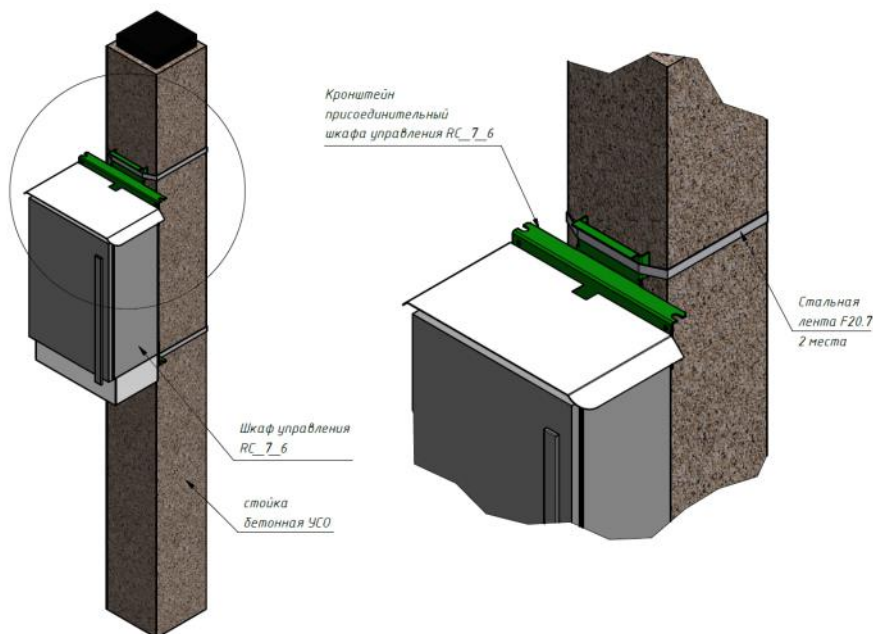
Крепление шкафа управления к железобетонной стойке
